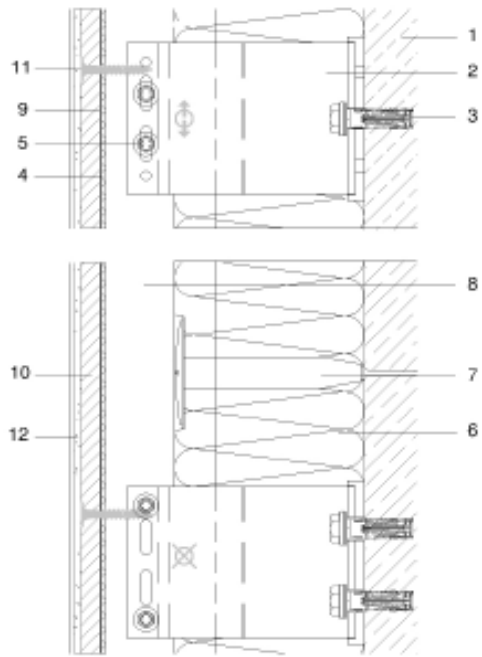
Detalhes construtivo de corte vertical do sistema [78].
